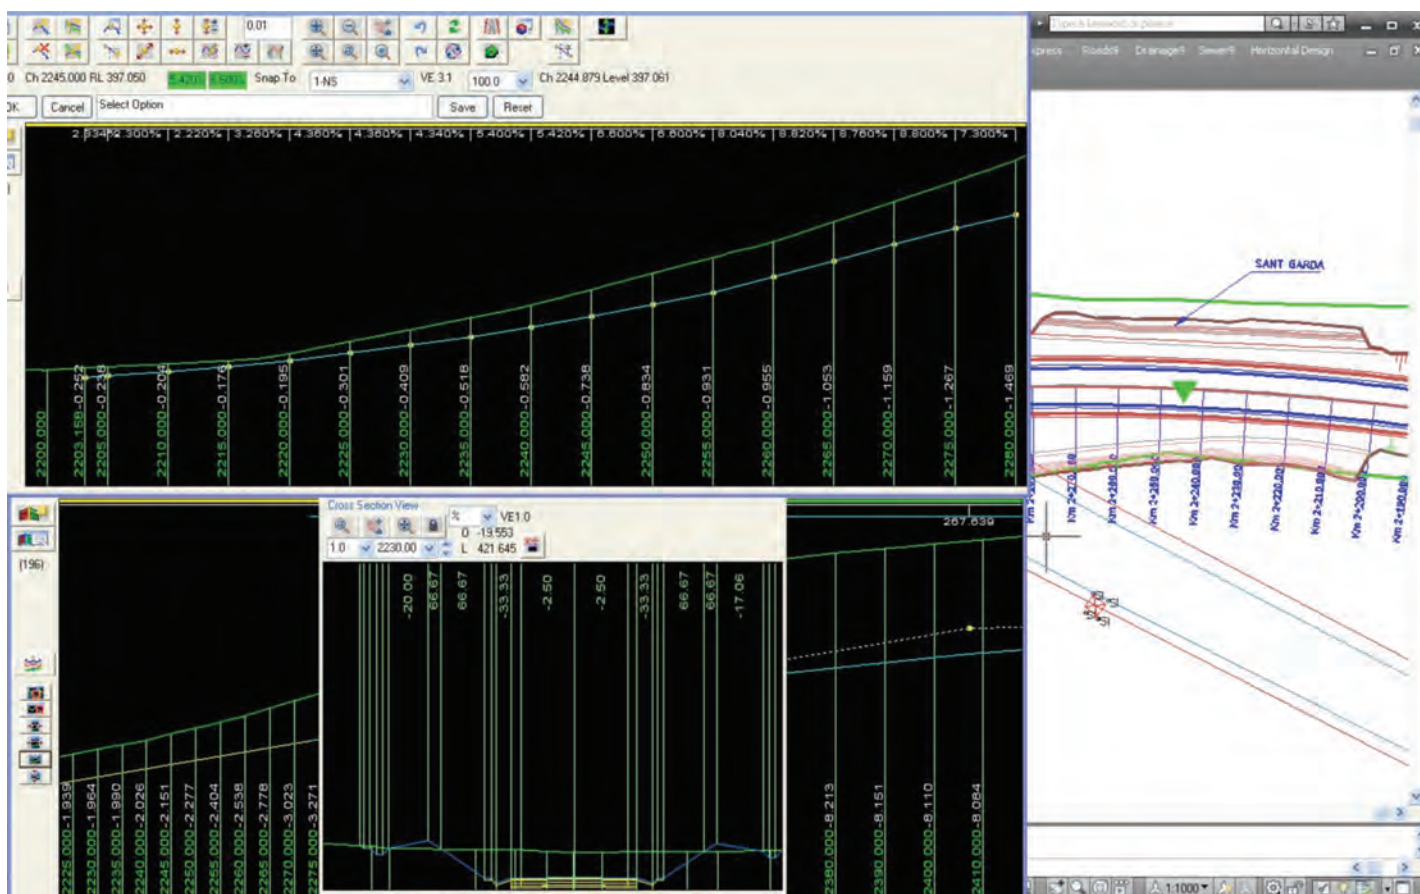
Profil transversal și longitudinal șanț de gardă
